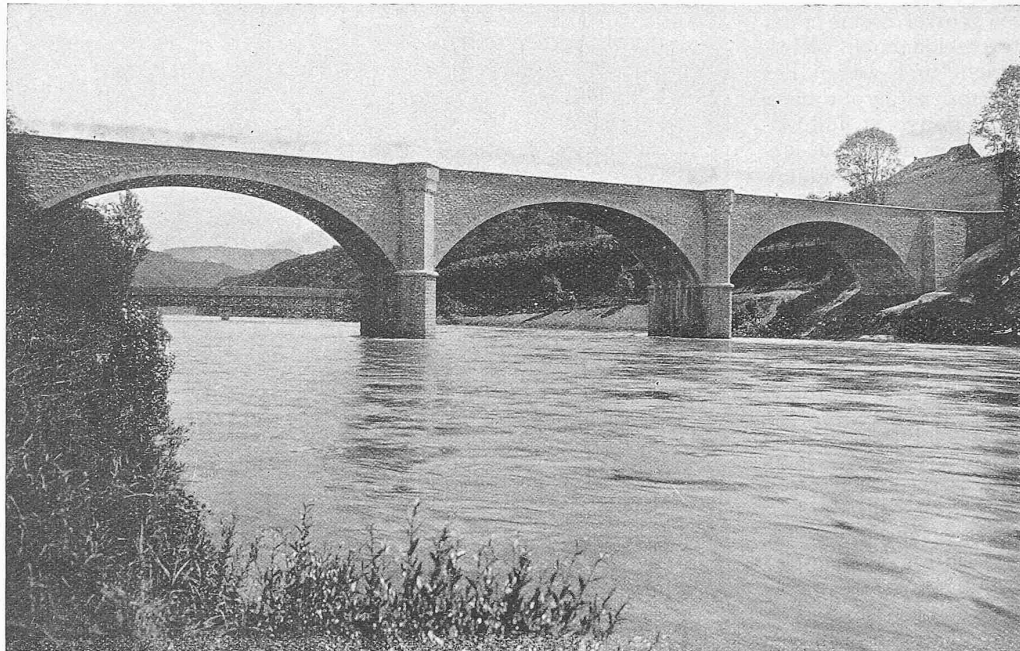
Die neue Rheinbrücke Eglisau vor der Einstauung; im Hintergrund die alte Holzbrücke.
